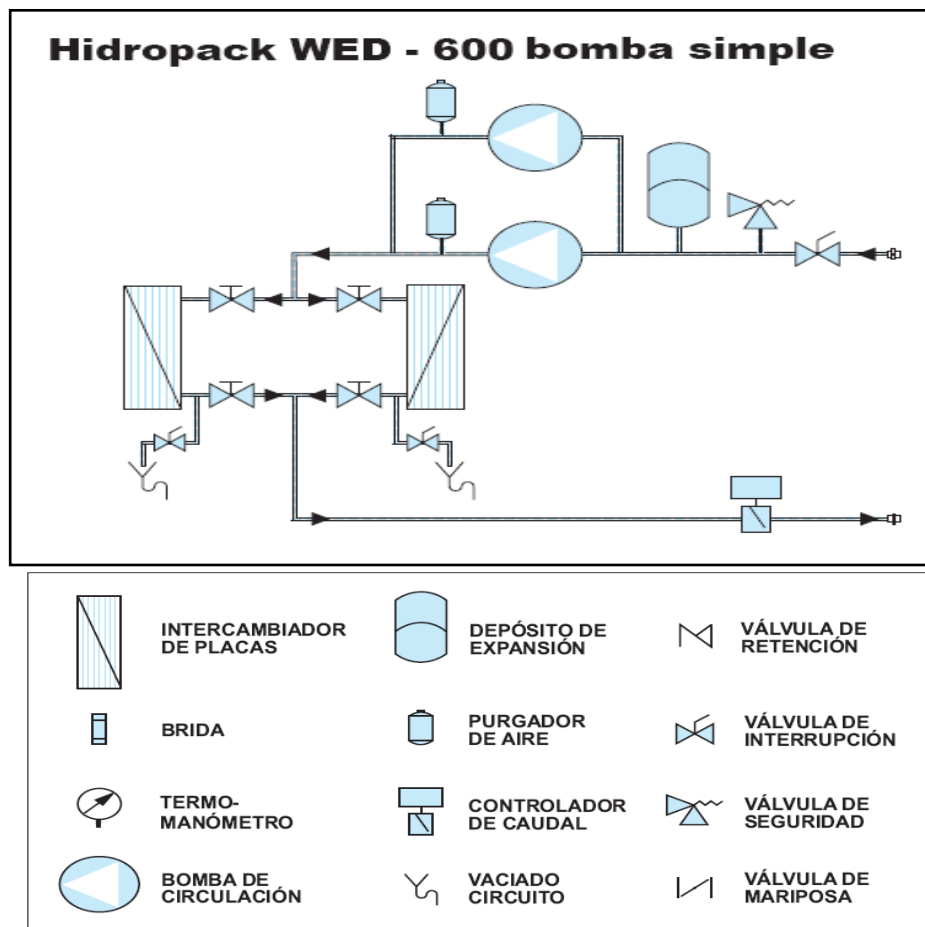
Eschema del equipo de bombeo WED.
